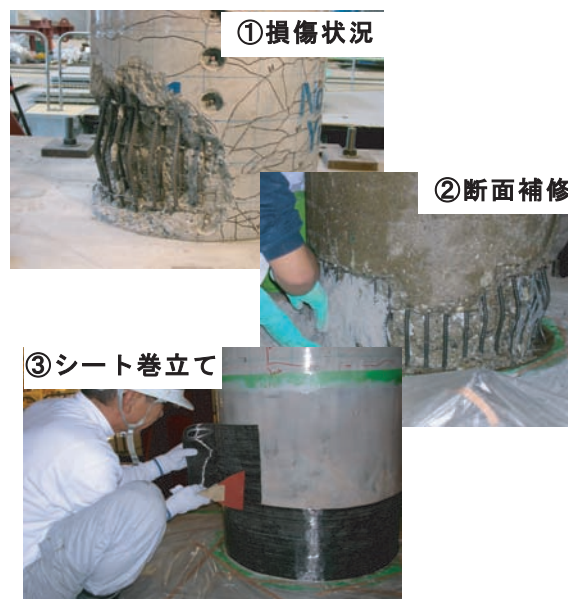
鉄筋コンクリート橋脚の迅速応急復旧
